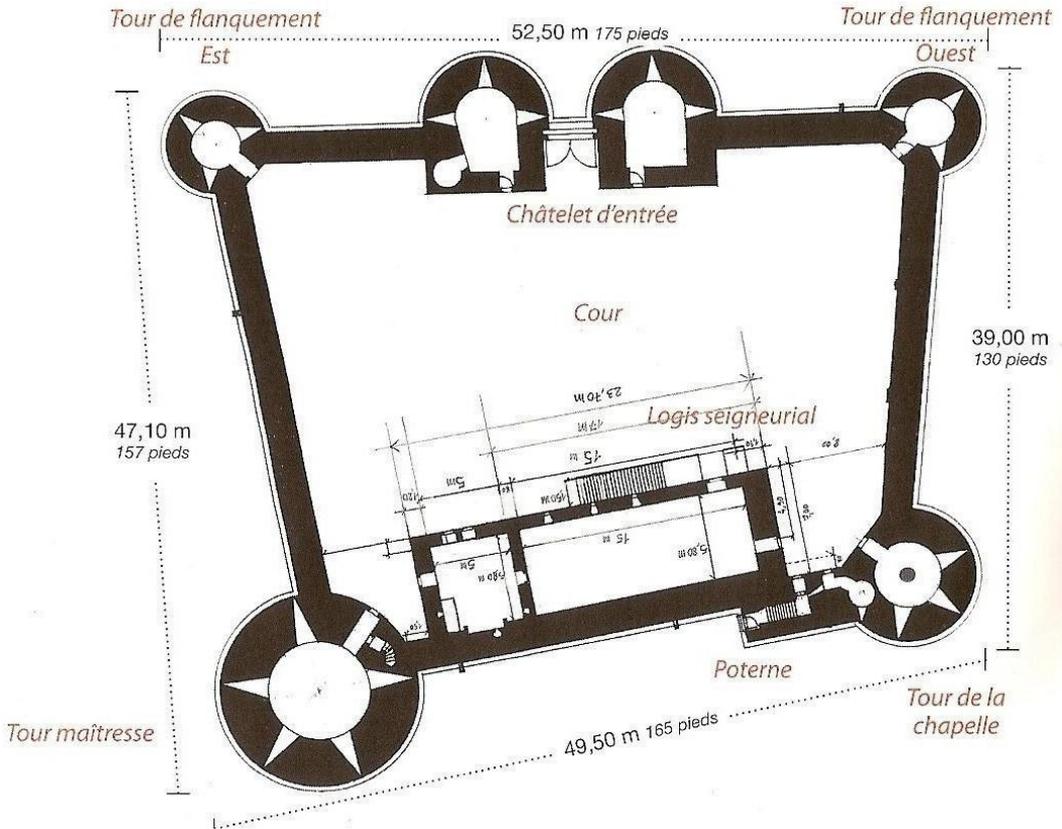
Grundrissplan nach Jacques Moulin. – Ground plan according to Jacques Moulin.
